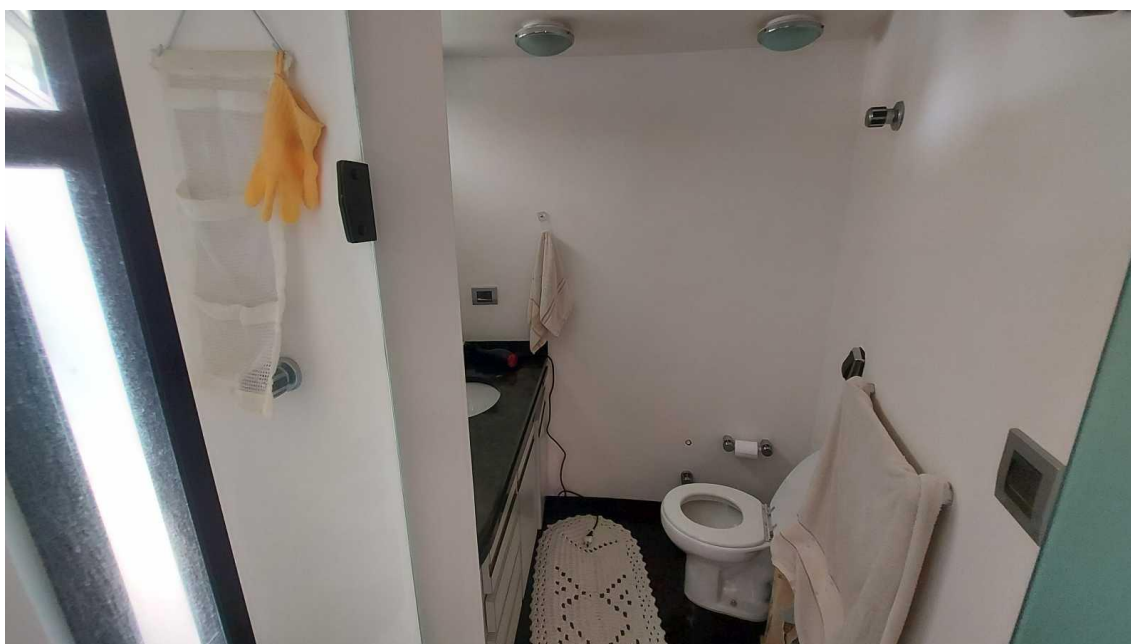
Banheiro da Suíte 2 - 1º Pavimento
